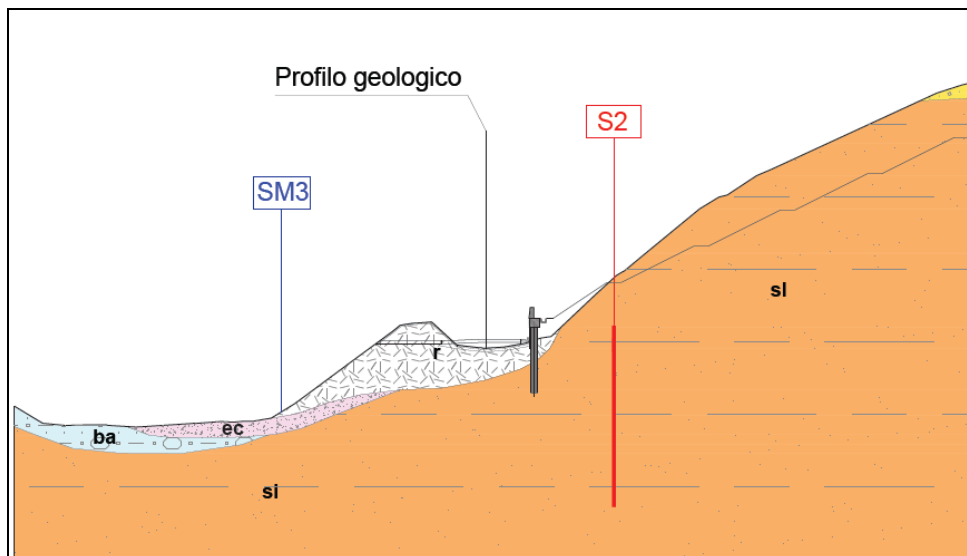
Stralcio della sezione geologica C-D posta trasversalmente rispetto al tracciato ed indicativa degli interventi previsti
